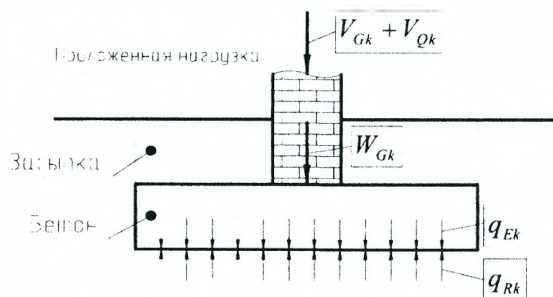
Вертикальные воздействия на ленточный фундамент
